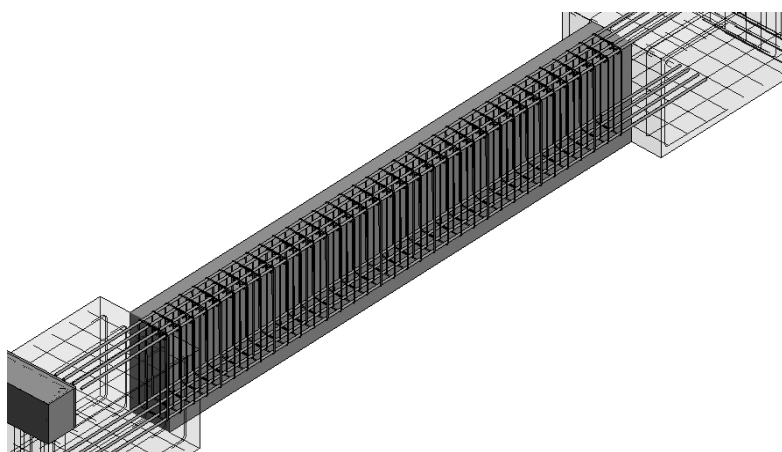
Modelos 3D de armaduras – Viga VE2 – 40 x 90 cm²
